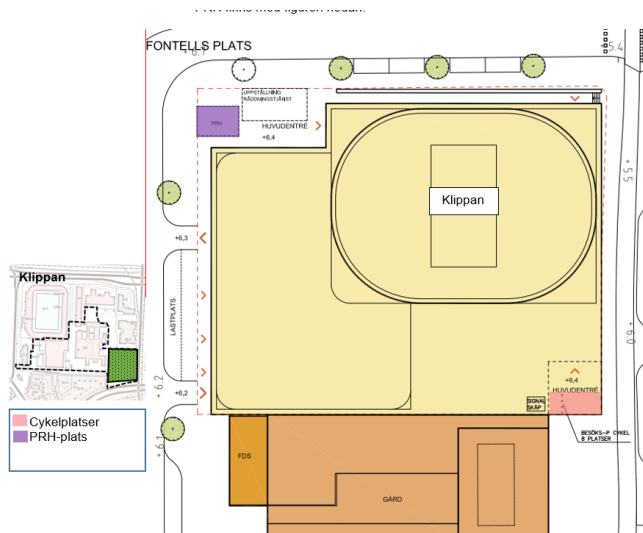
Parkeringslösning för bil och cykel i markplan, Wallenstam
